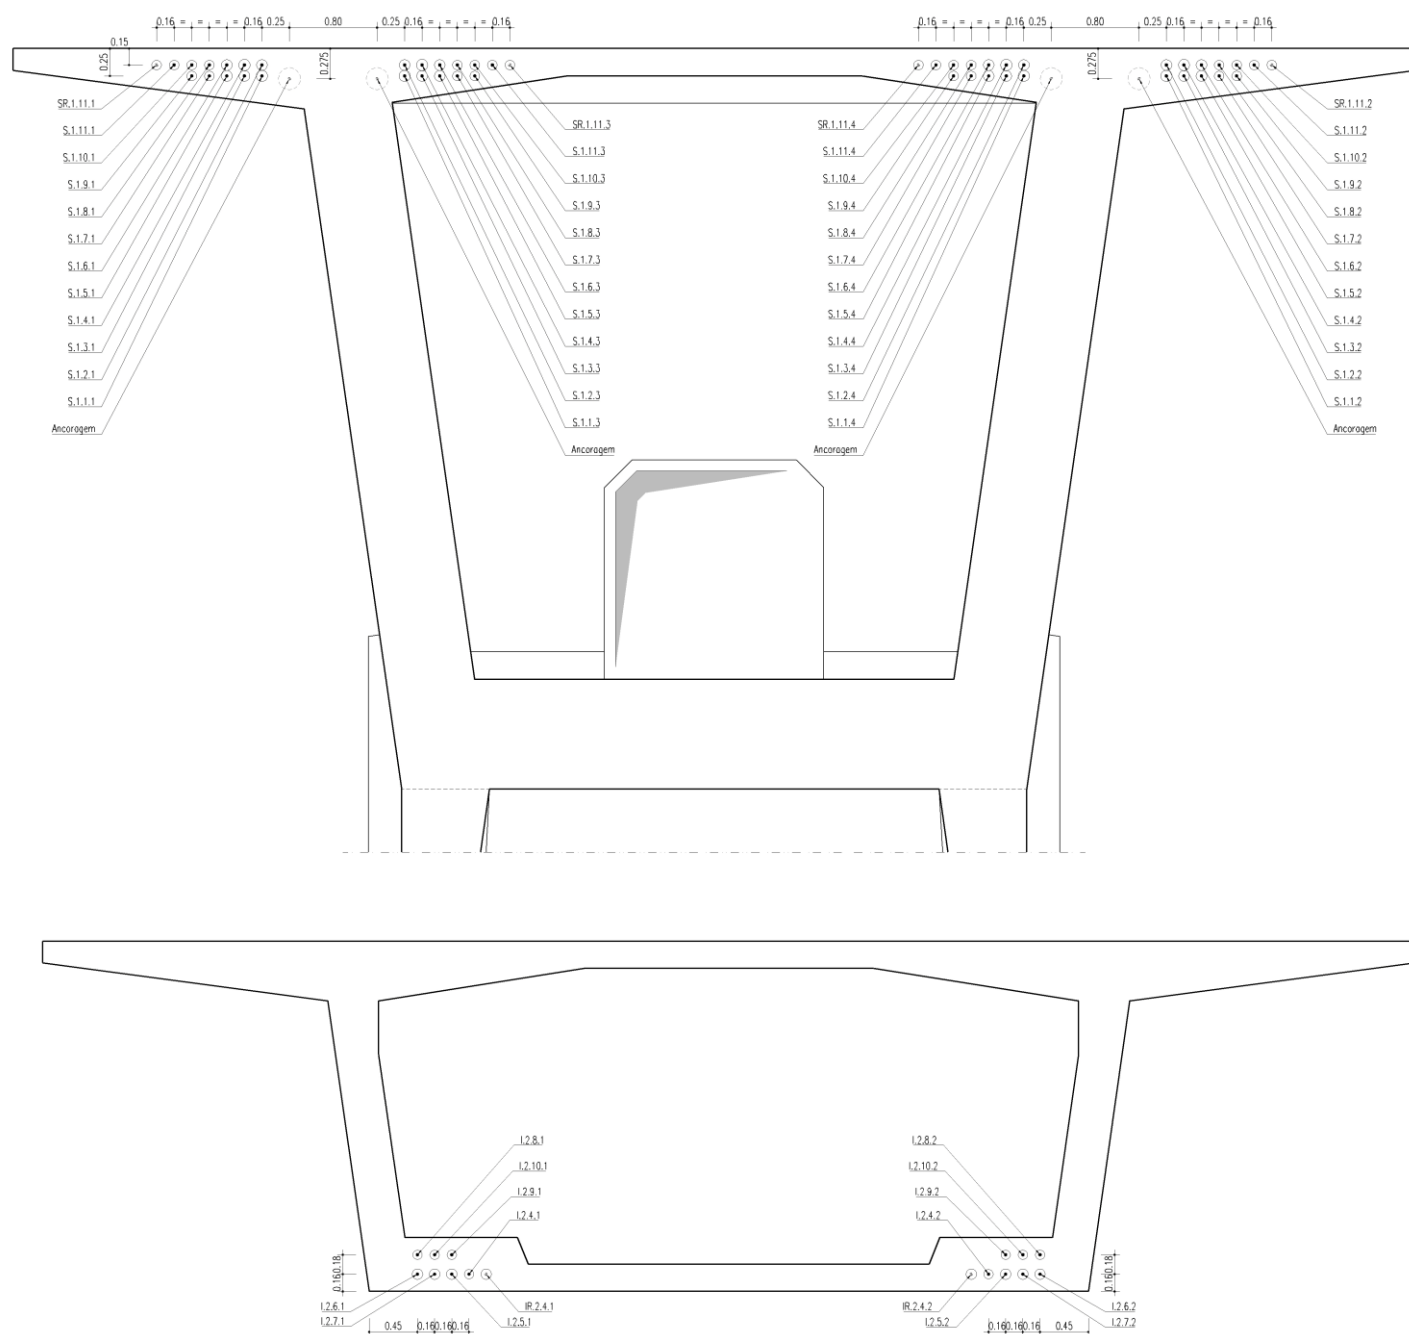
Traçado dos Cabos de Pré-esforço: Secções Transversais: AD0 e Meio Vão
